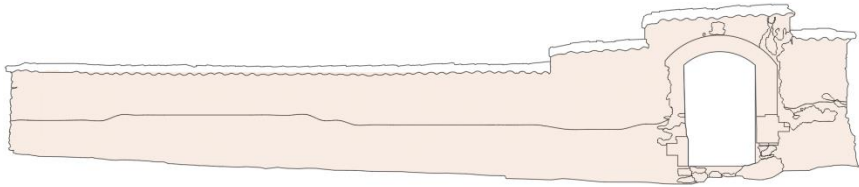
Esquema de planta-alzado Sur a fachada principal estado actual. Fuente propia.
